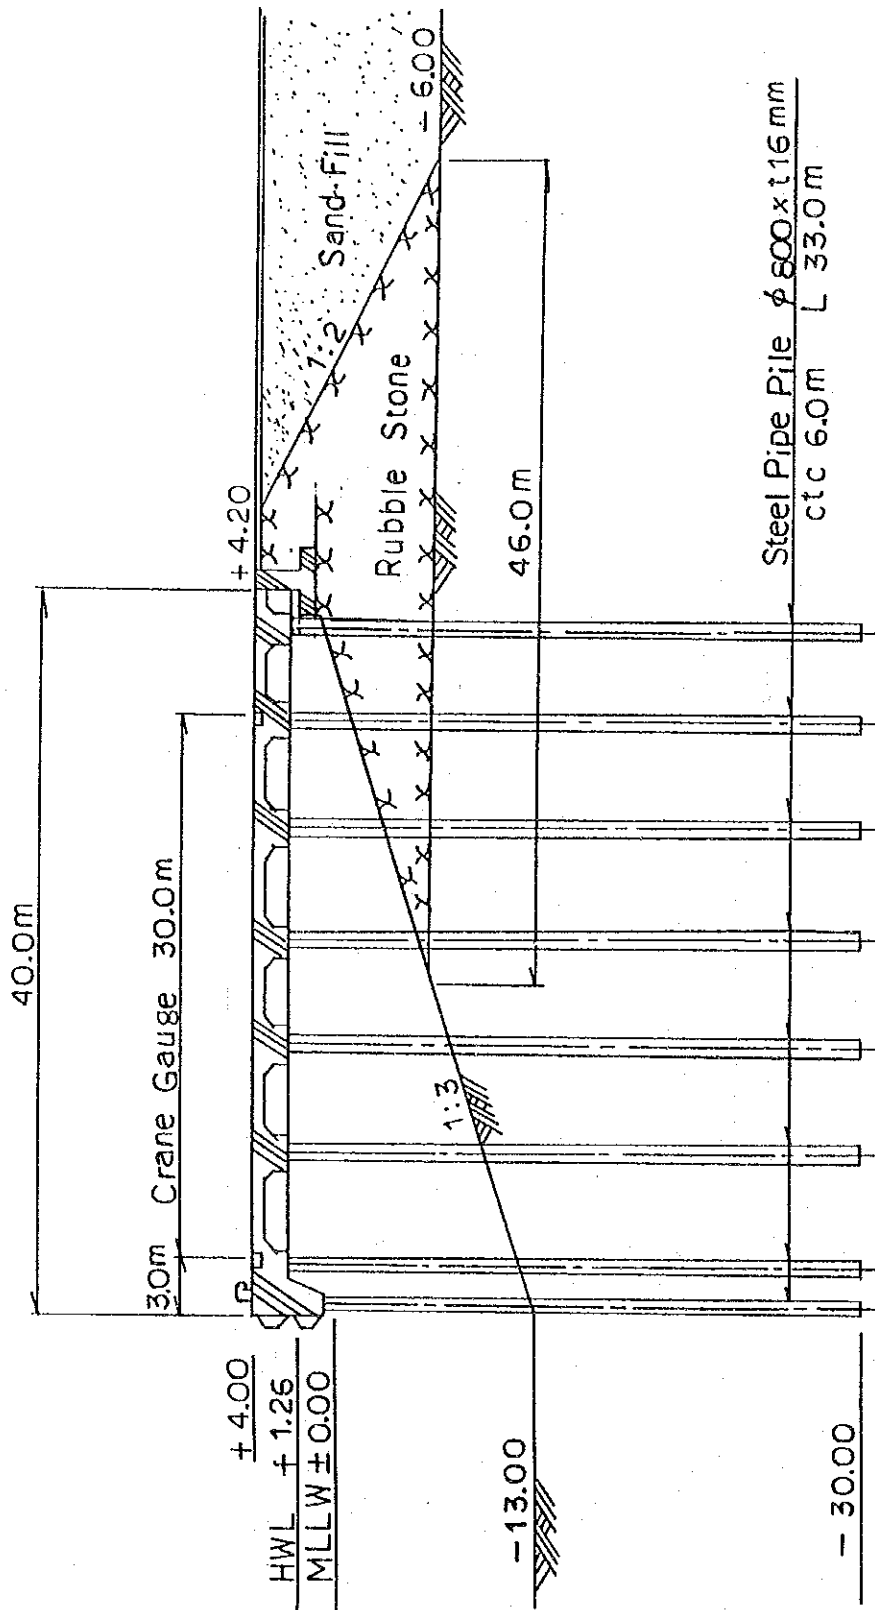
サングレールポイント-13mコンテナナバース標準断面図
